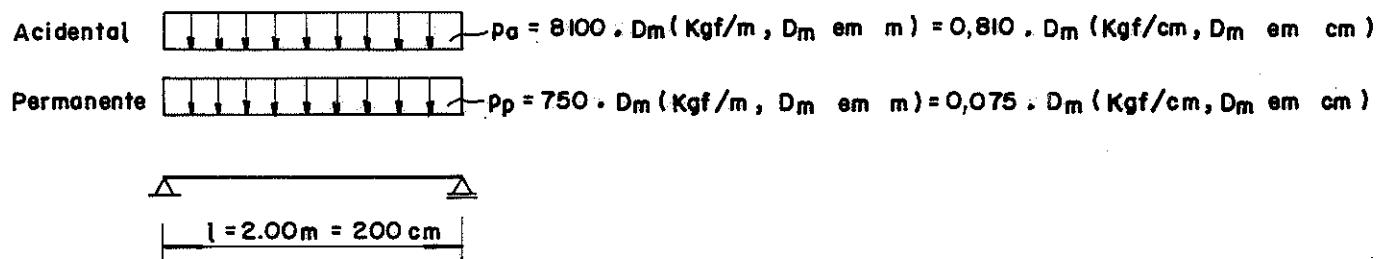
ESQUEMA ESTÁTICO E CARREGAMENTOS DA VIGA DO TABULEIRO
